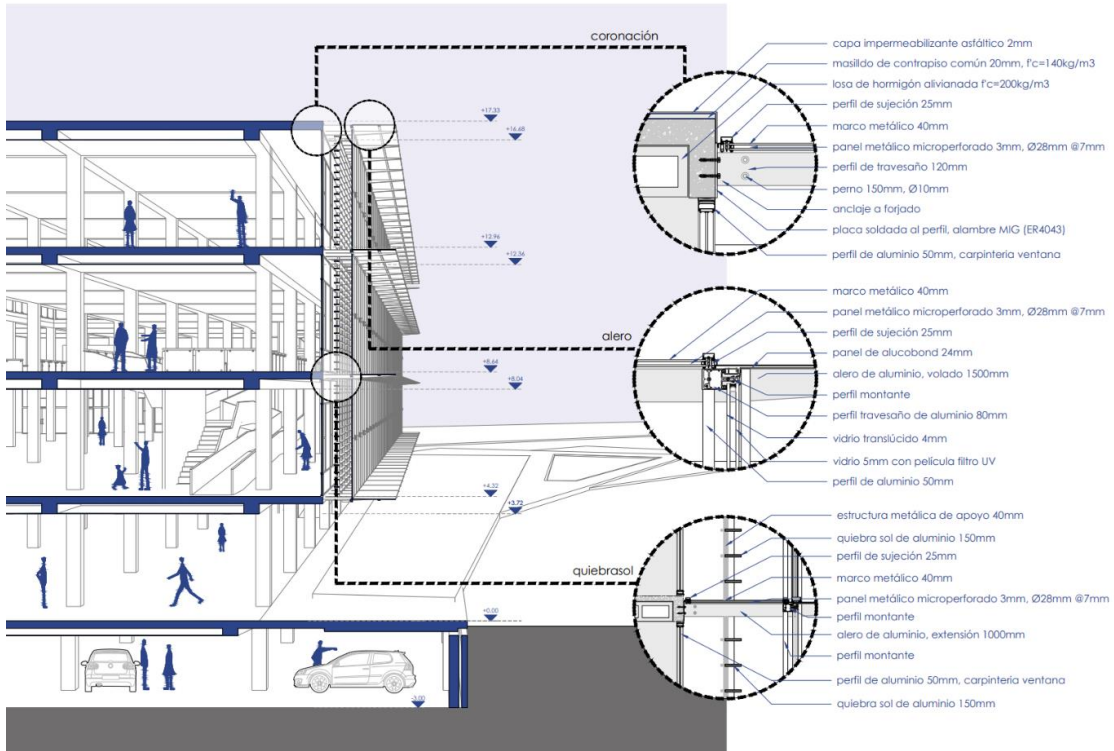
Corte Constructivo Fachada Muro Cortina. Elaboración propia.
